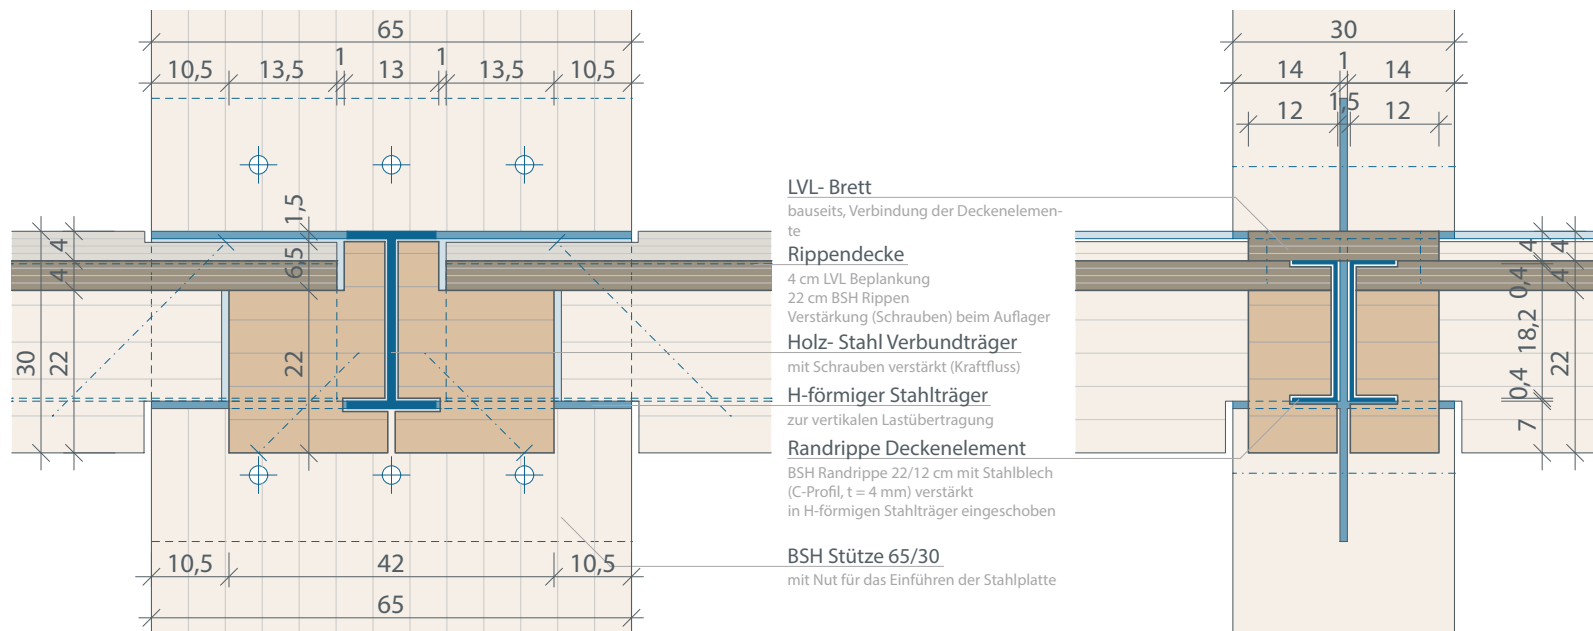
Alternativlösung Tragwerk - Querschnitt 3-1, mit LVL- Ergänzungen in den BSH- Elementen
